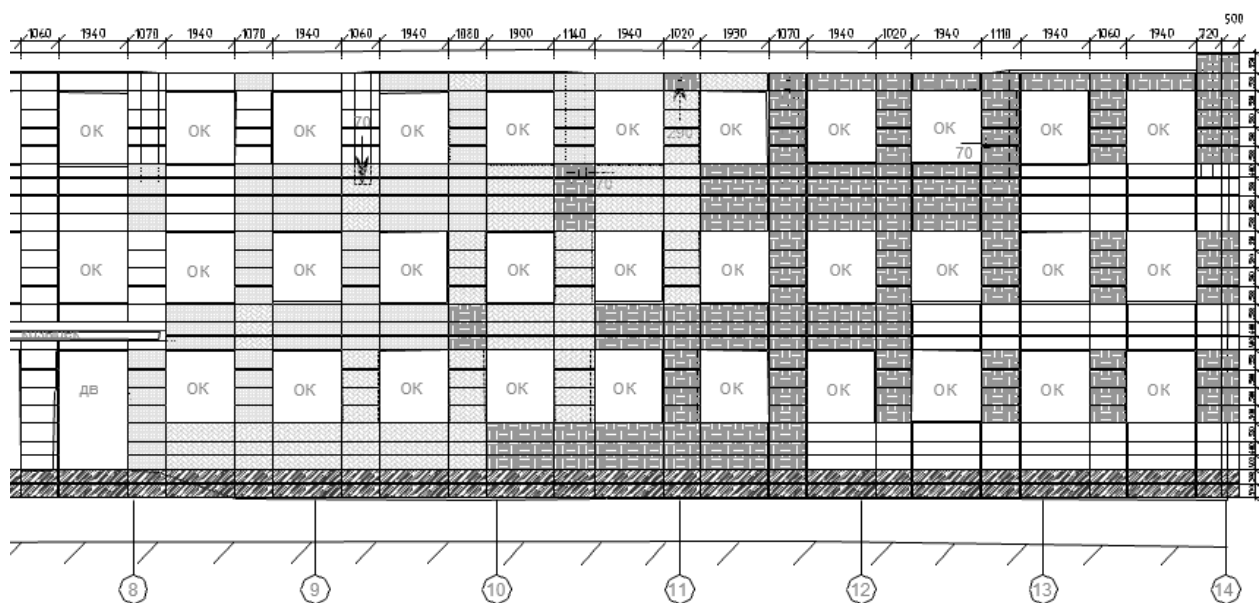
Раскладка кассет на фасаде в осях 8–14.
